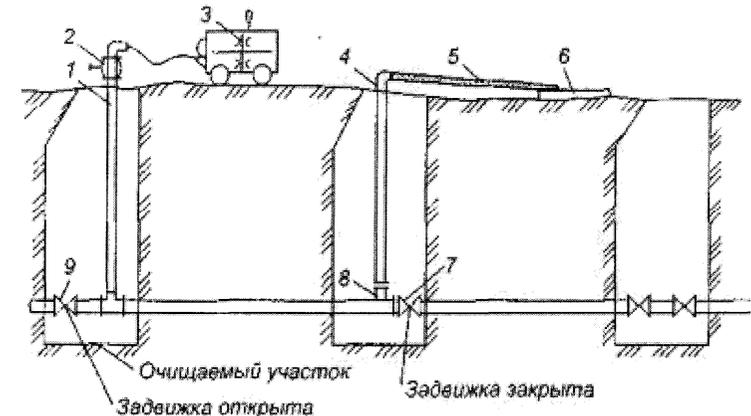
Схема промывки водопроводной сети гидропневматическим способом: 1 – напорный стояк; 2 – вентиль; 3 – передвижной компрессор; 4 – отводной стояк; 5 – рукав; 6 – лоток; 7, 9 – задвижки; 8 – подставка пожарного гидранта
